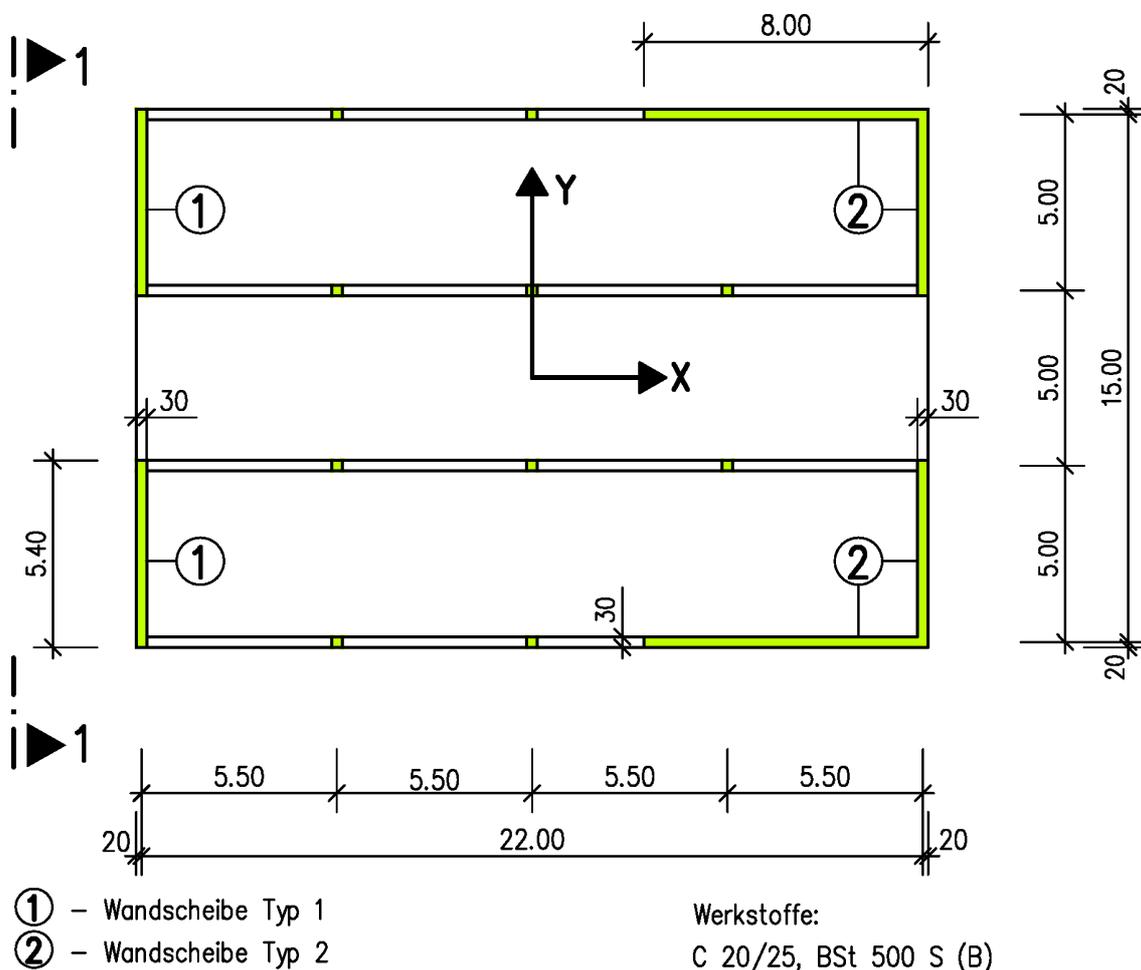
Mehrgeschossiges Wandscheibenbauwerk – Geschossgrundriss
